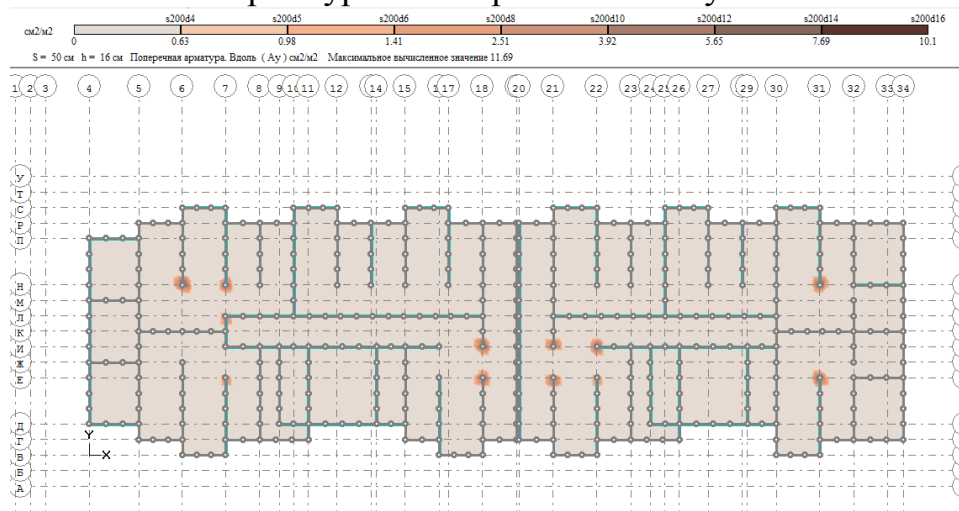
Площа поперечного перерізу, діаметр і крок вертикального арматурного стержня.
